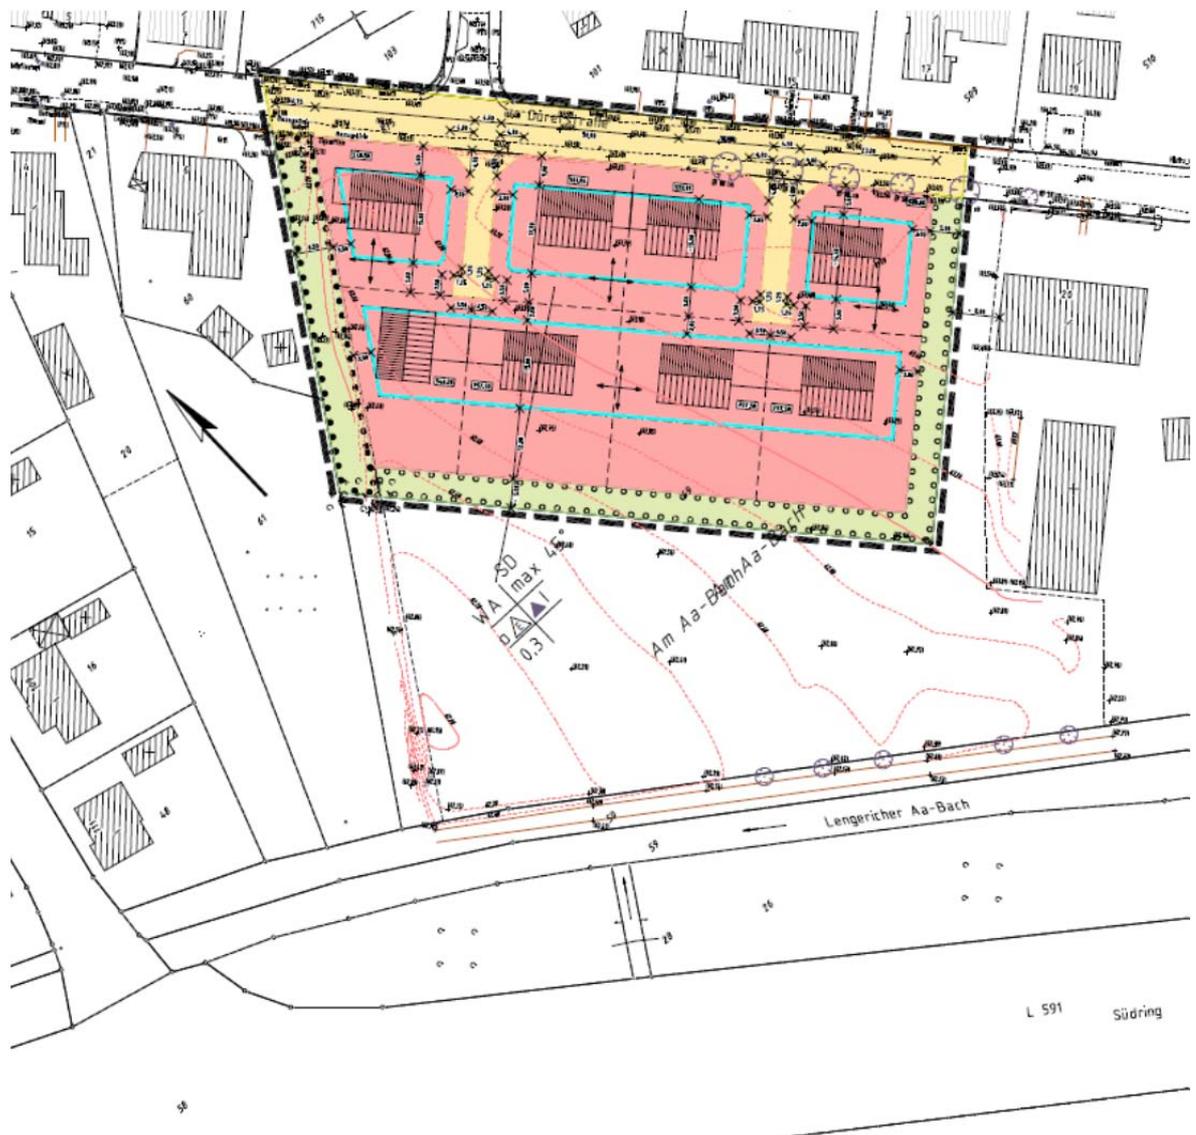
Entwurf des Bebauungsplans Nr. 55 „Dürerstraße“
